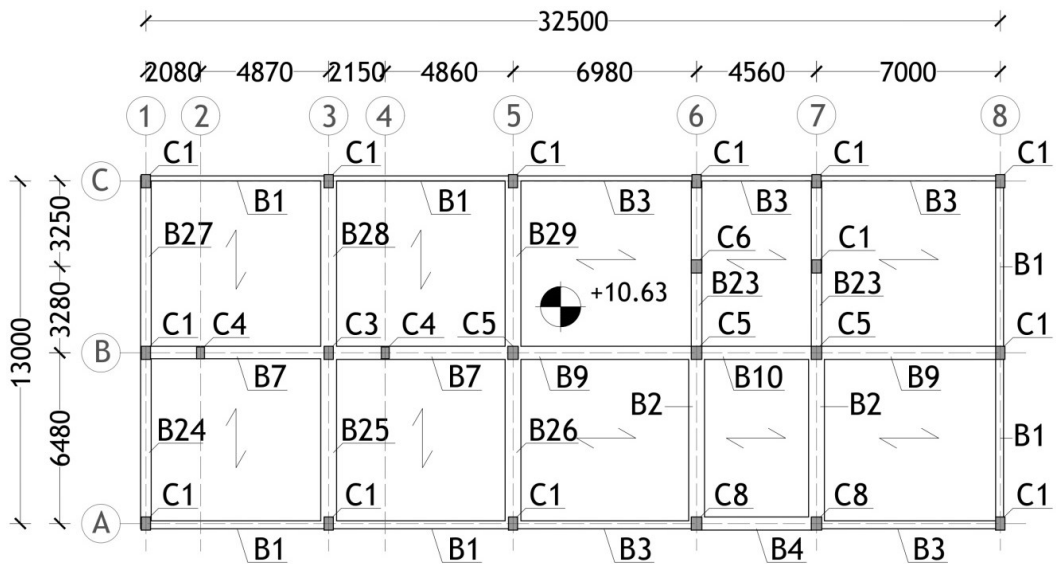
Pianta strutturale del terzo impalcato a quota +10.63 m
